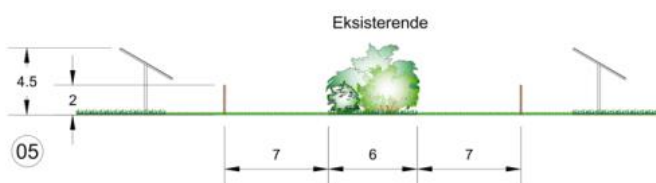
Snit 5 langs eksisterende beplantningsbælte mellem to markstykker nord for gården Mørup.
